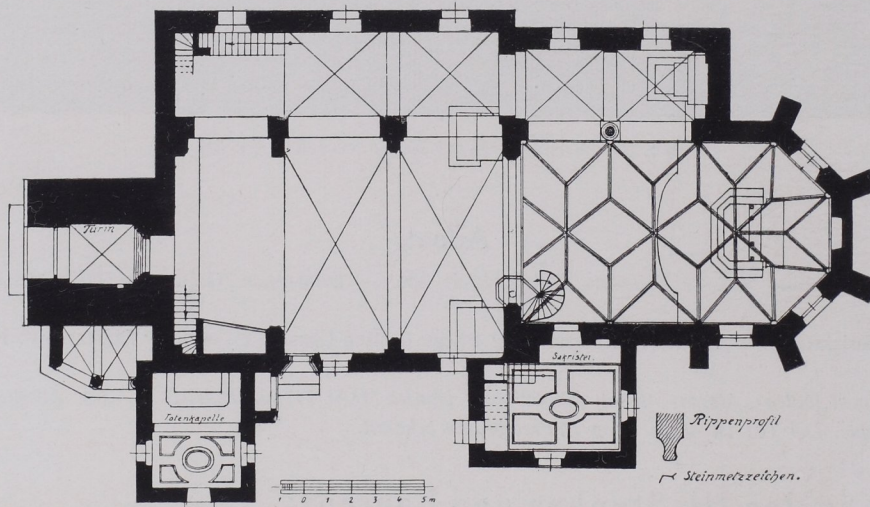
Adnet, Pfarrkirche, Grundriß 1:300 (S. 38).
